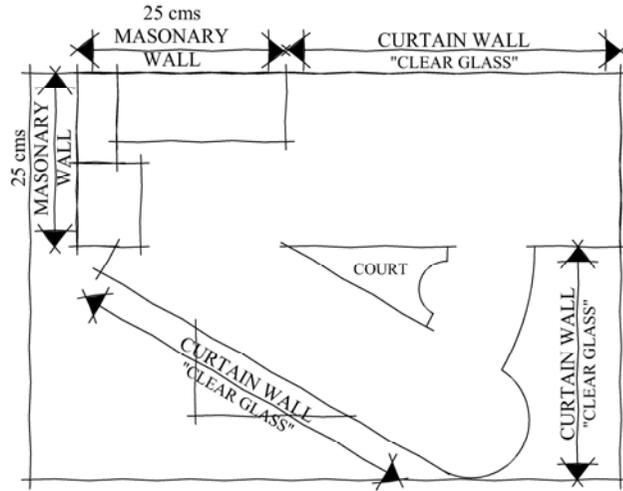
المسقط الأفقي للدور المتكرر
